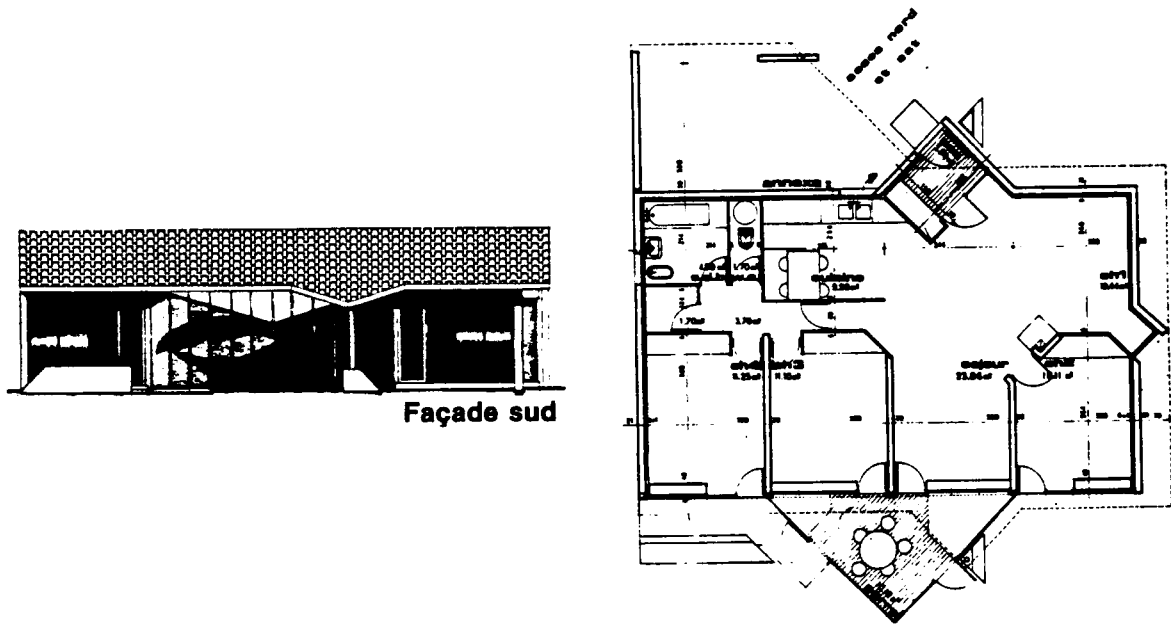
Exemple de plan "bioclimatique" sur un seul niveau : séjour au Sud, logement traversant : Maison "CAPELIO", Architecte: Groupe ERSOL (lauréat concours "5000 Maisons solaires").
